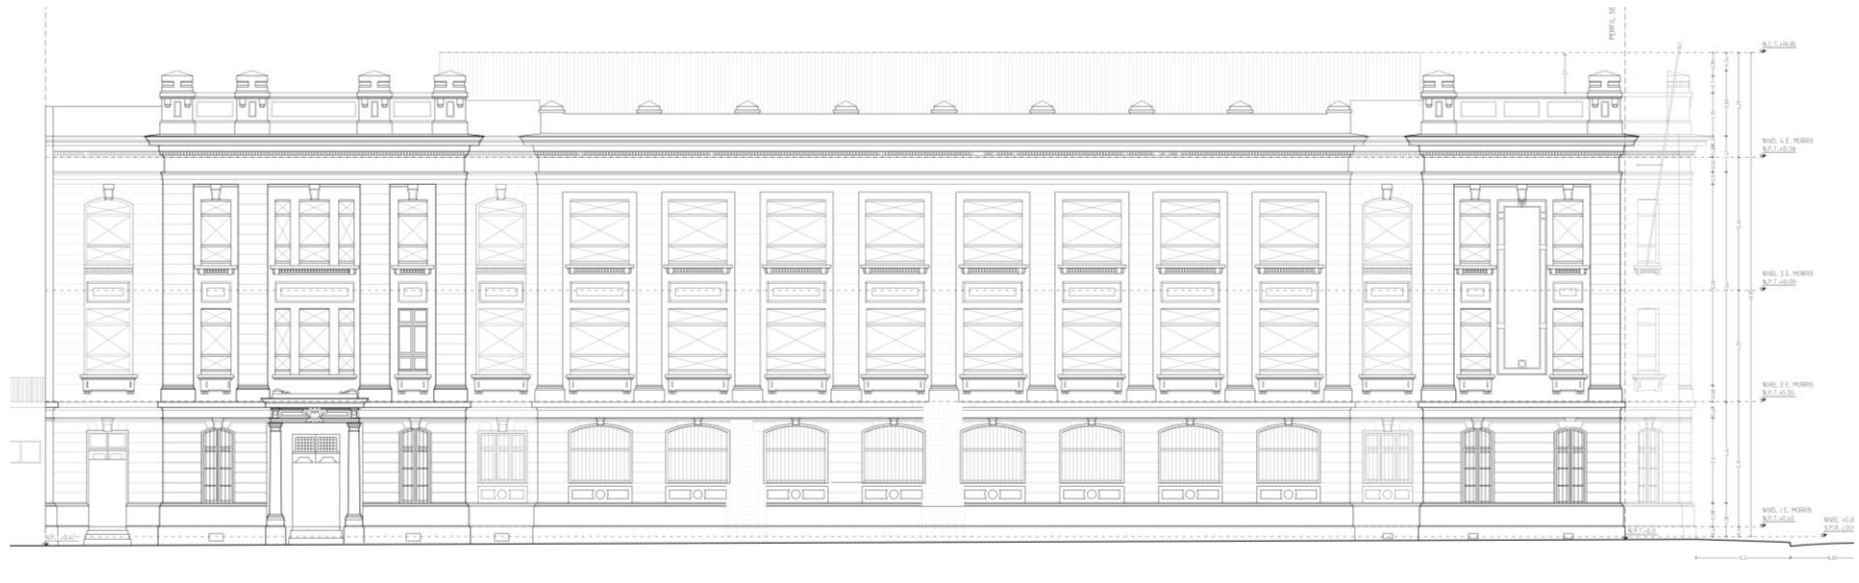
Elevación Fachada Morris previo a la intervención. Fuente: Cyparq.
